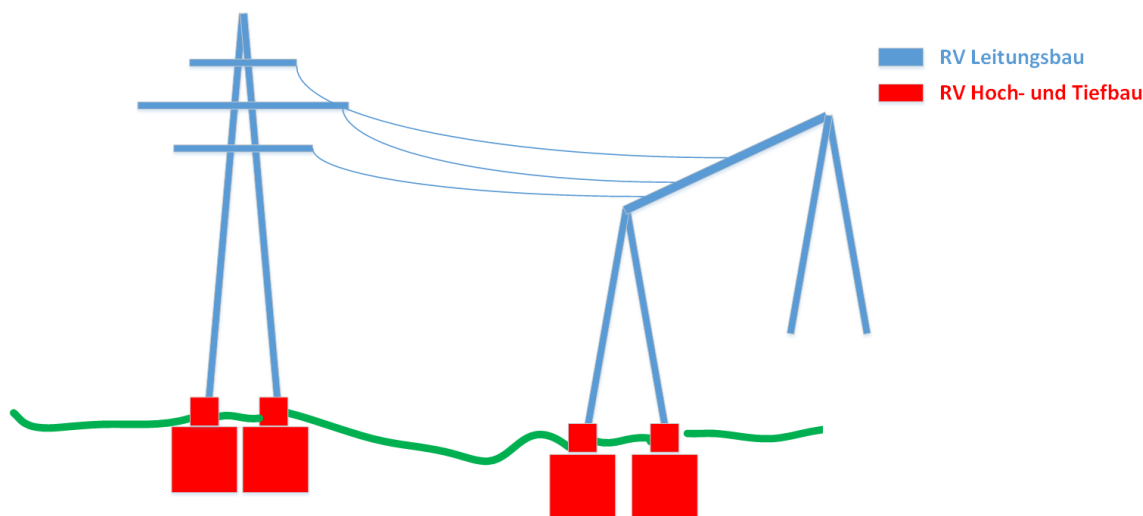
Schnittstelle Rahmenvertrag (RV) Hoch- / Tiefbau Planer (rot) zu Leitungsbau Planer (blau)
